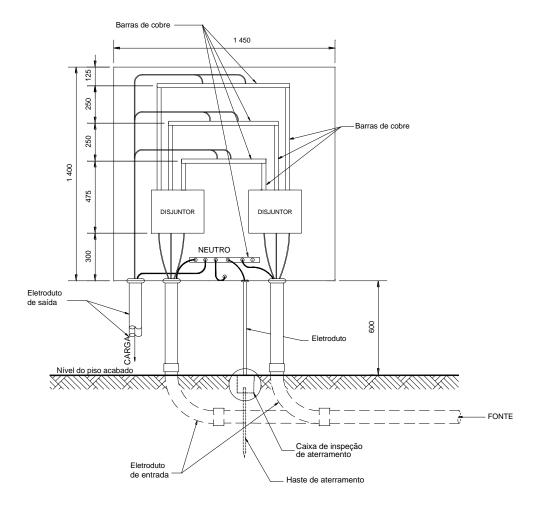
Instalação da proteção da caixa seccionadora tipo X
